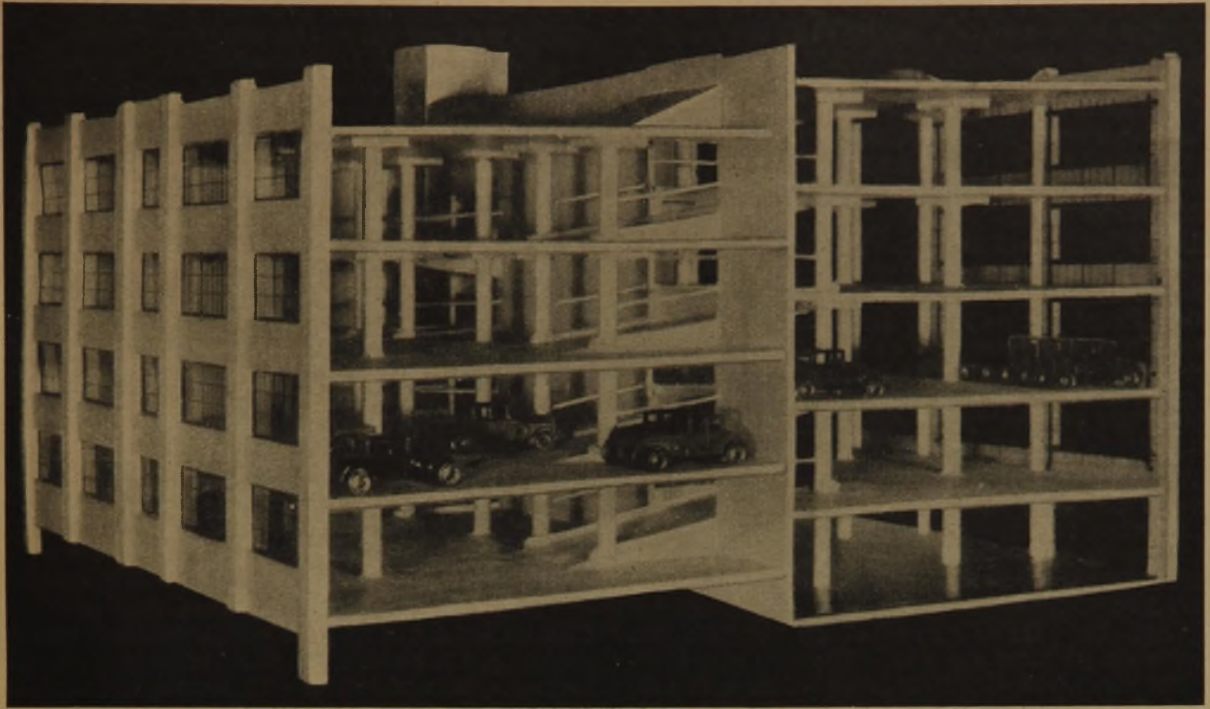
Modell einer amerik. Kurzrampen-Garage mit versetzten Geschossen.
